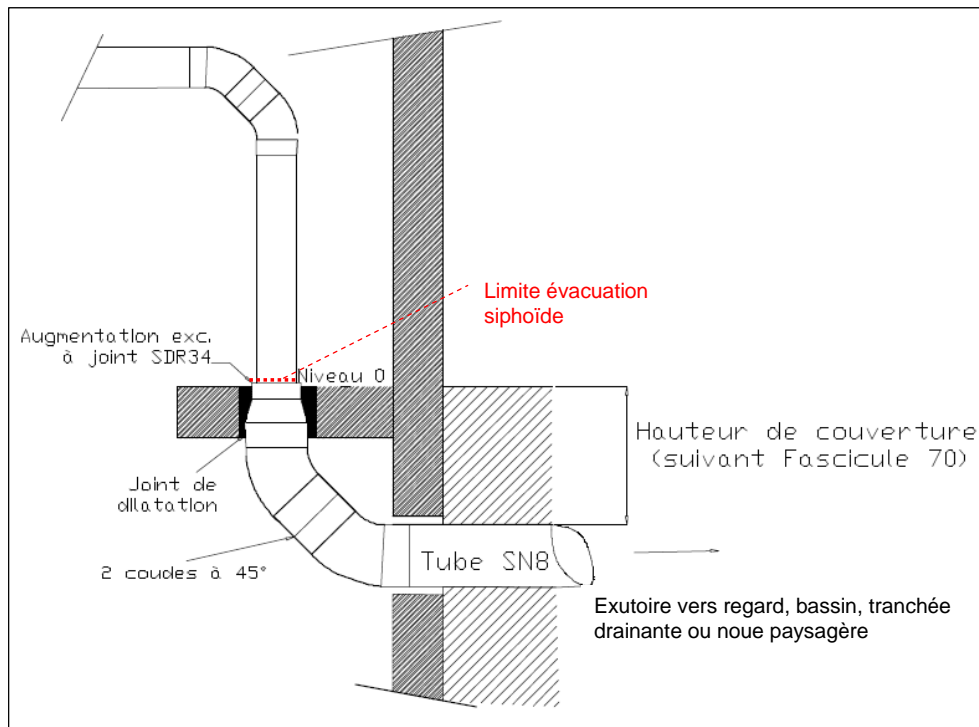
Figure N – Exemple de raccordement sous dalle - Cas n° 3
